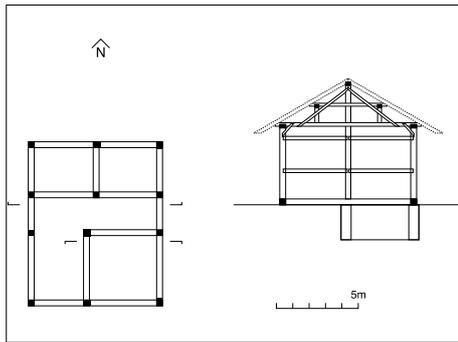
Haus Dorfstrasse 6/8, Zug ZG, Schematischer Grundriss und Schnitt.
